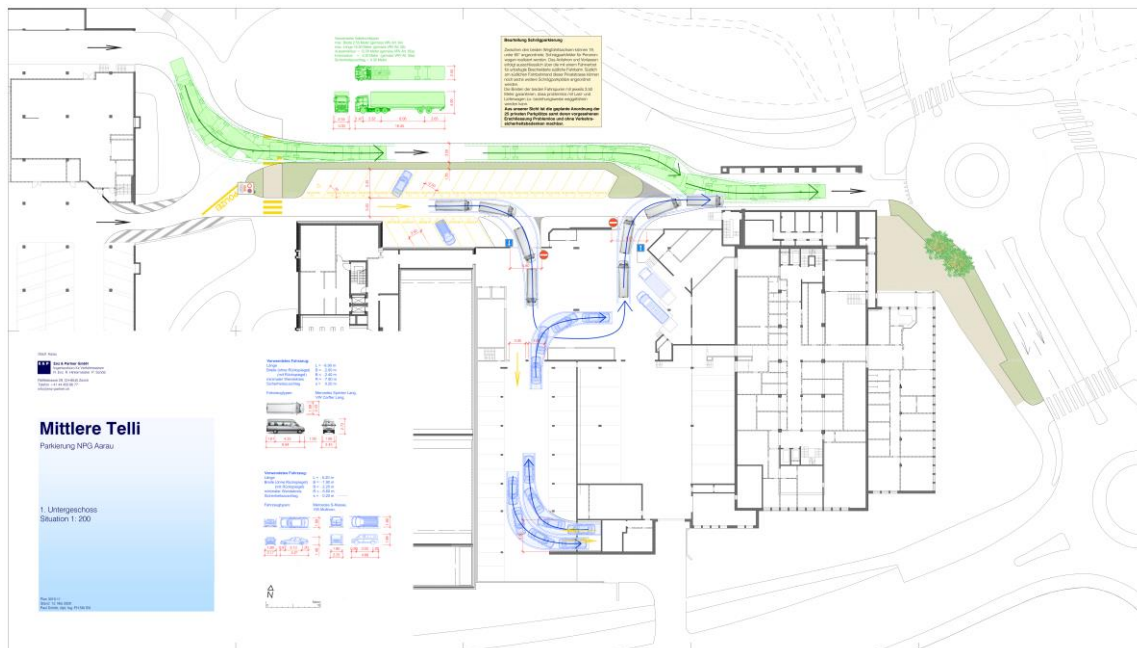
Grundrissplan 1. Untergeschoss Parkierung und Strassenführung
